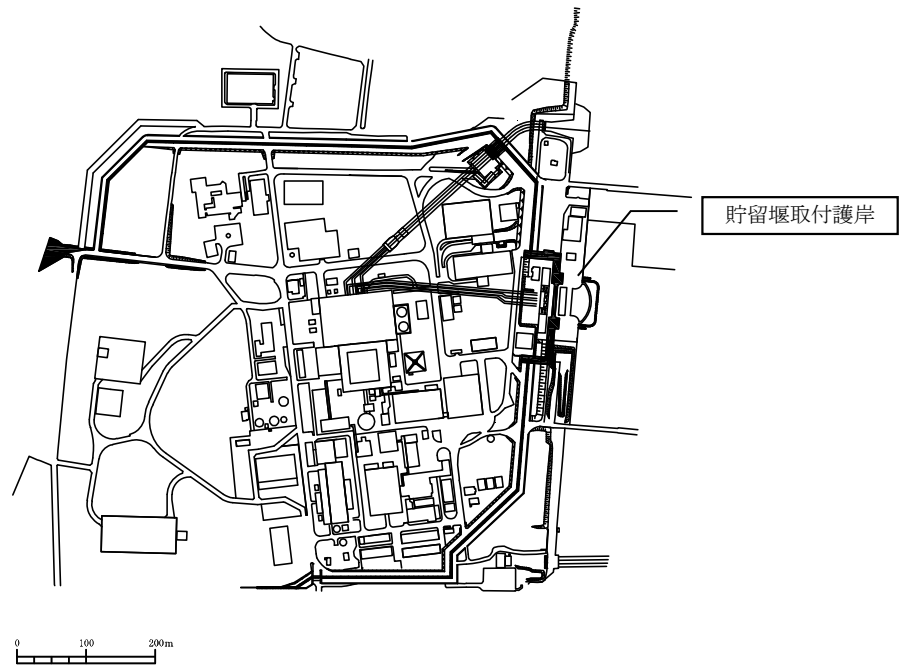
(1) 貯留堰取付護岸の平面配置図 (全体図)
